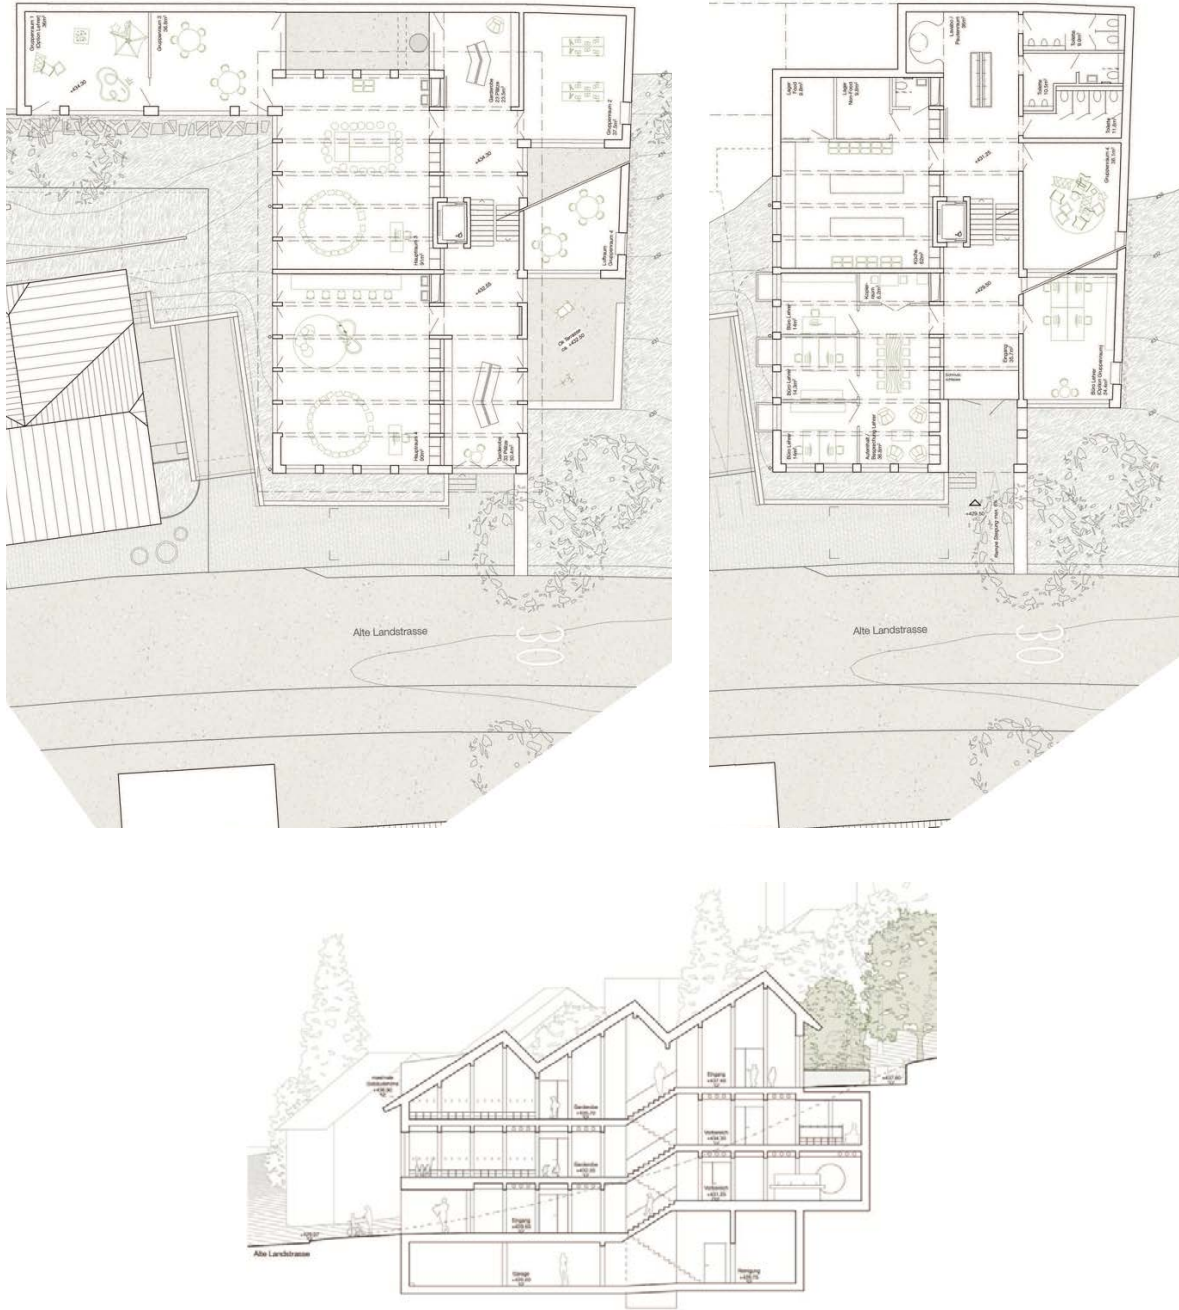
Grundrisse und Schnitt (v. o. l. n. u. r.)
